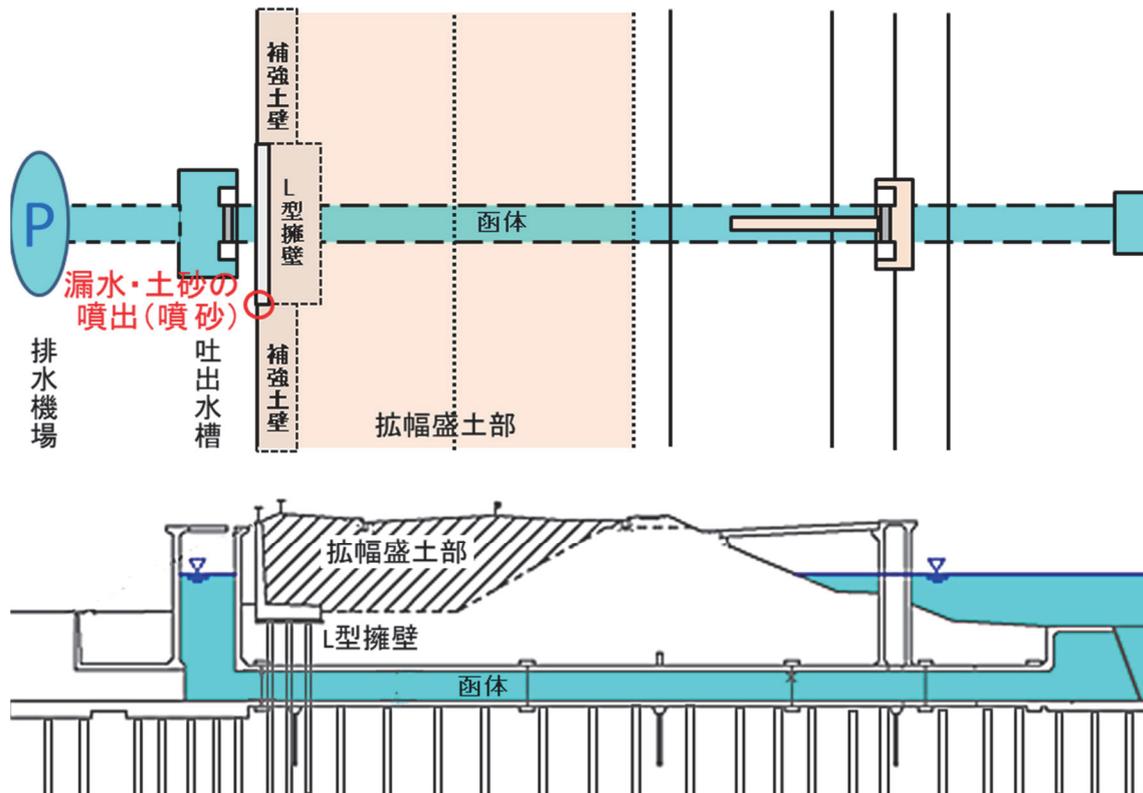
漏水・土砂の噴出（噴砂）発生箇所平面図・断面図
